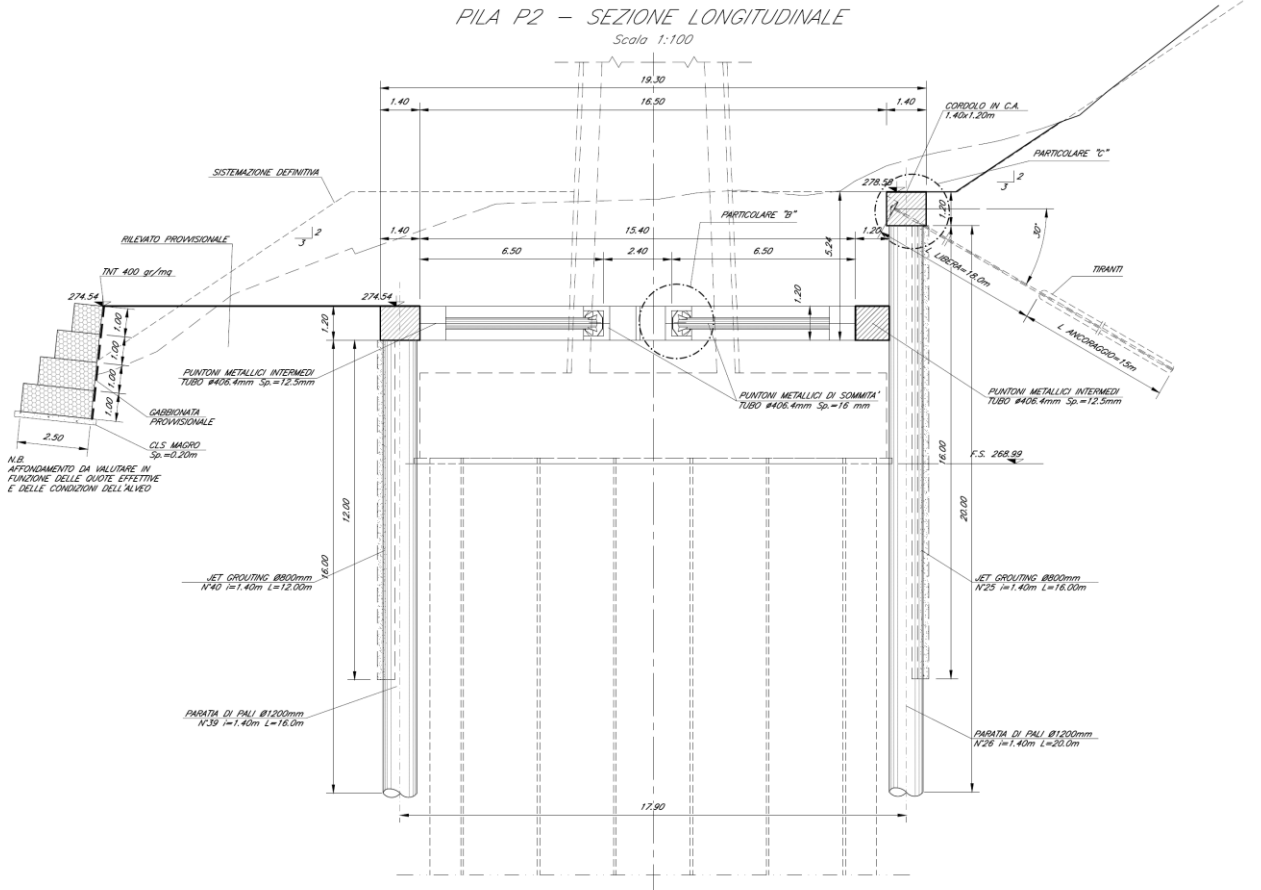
Sezione longitudinale interventi opere di sostegno pila P2
